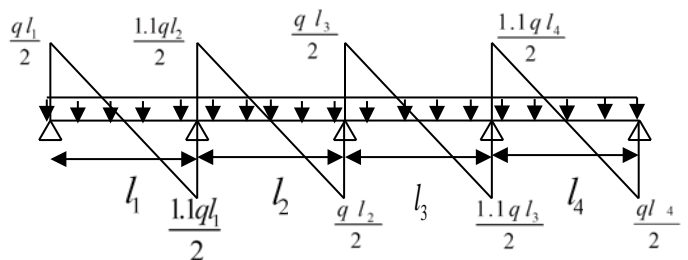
Effort tranchant d'une poutre à plus de 2 travées
